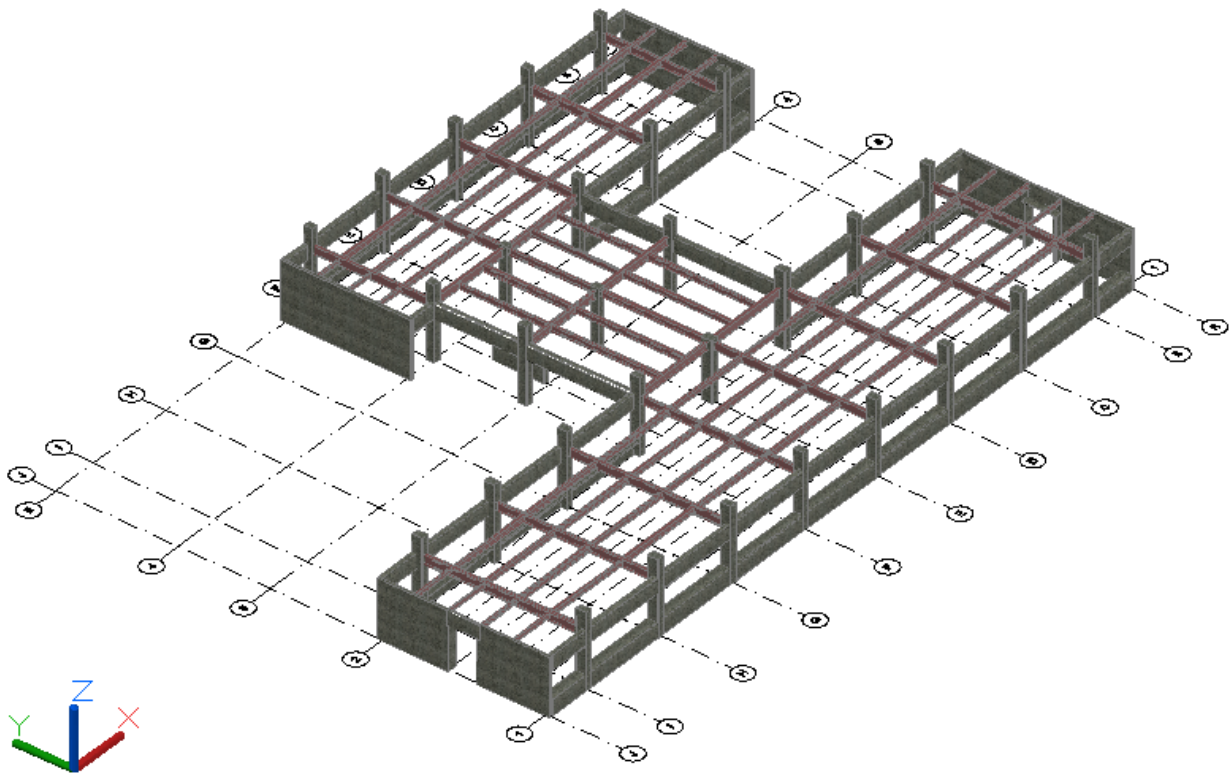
Vista en 3D de la estructura del Nivel 2
